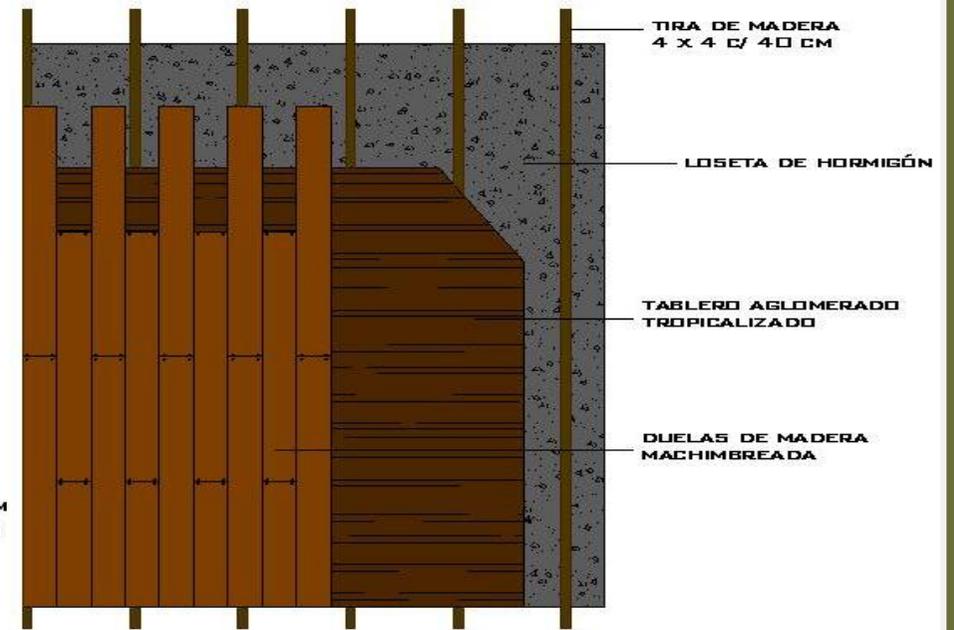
PISO DE MADERA SOBRE LOSETA DE HORMIGÓN
